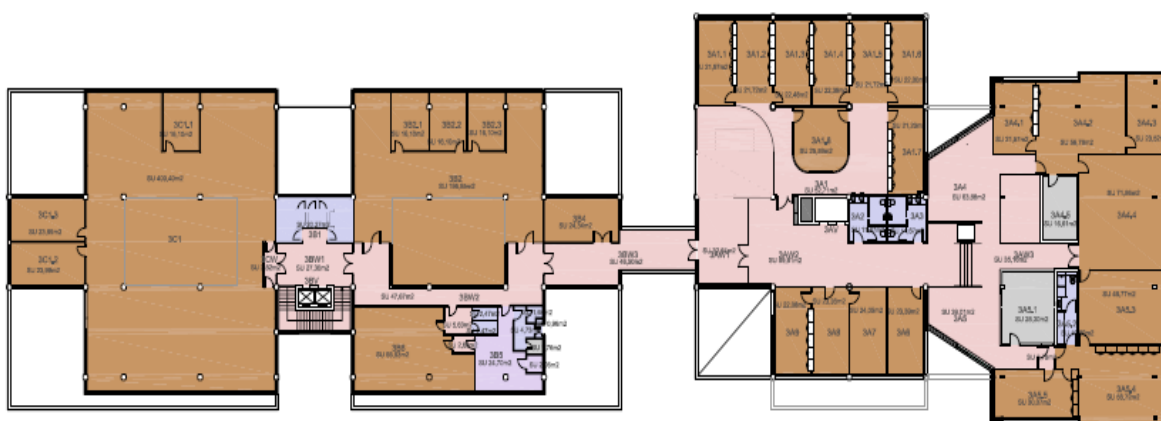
Imagen del plano de la 3ª planta del edificio bajo estudio.
